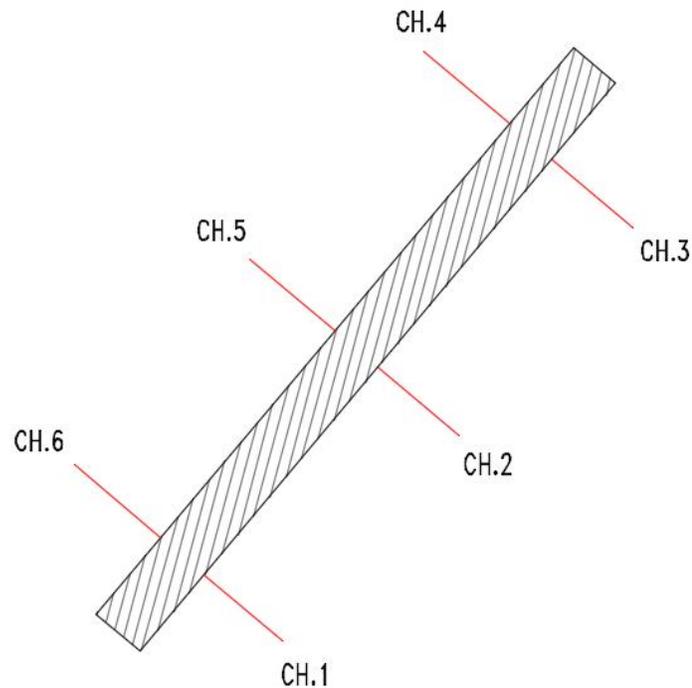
"Levantamiento en planta de chimeneas inclinadas; numeración de Chimeneas para Vertedero Industrial Dicham. Construcción propia"
